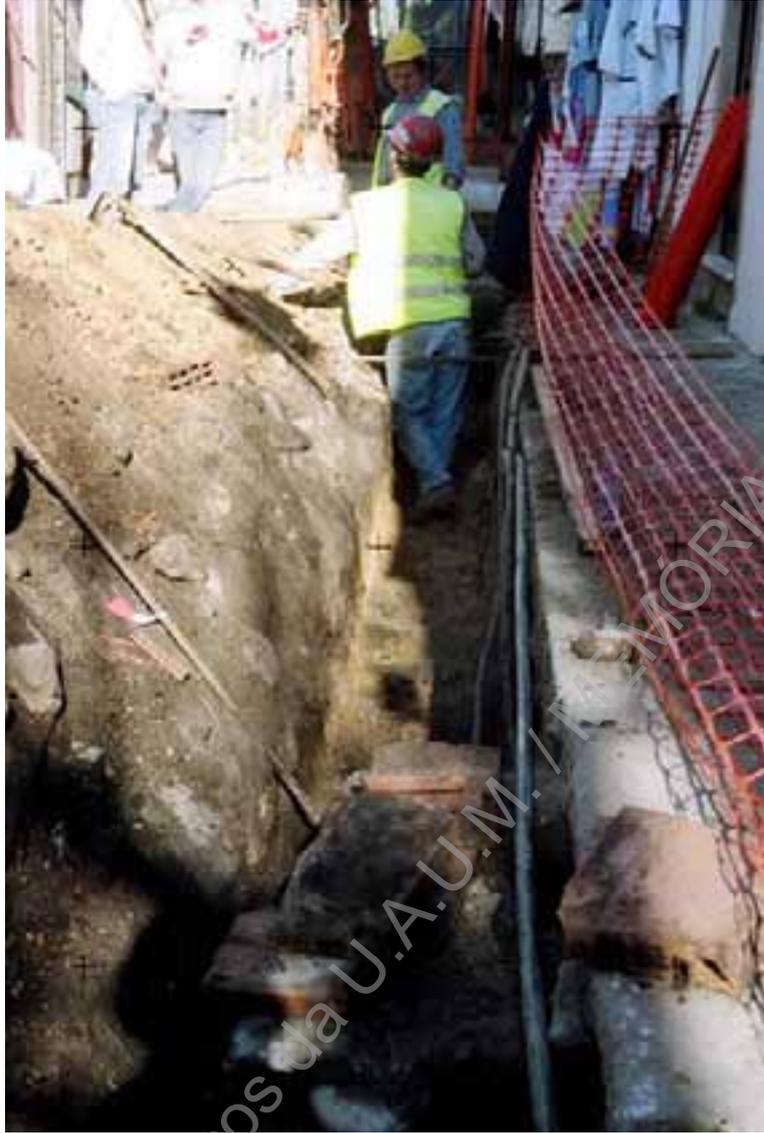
(A524) – Rua 5 de Outubro, pormenor da vala para implantação das canalizações provisórias.
